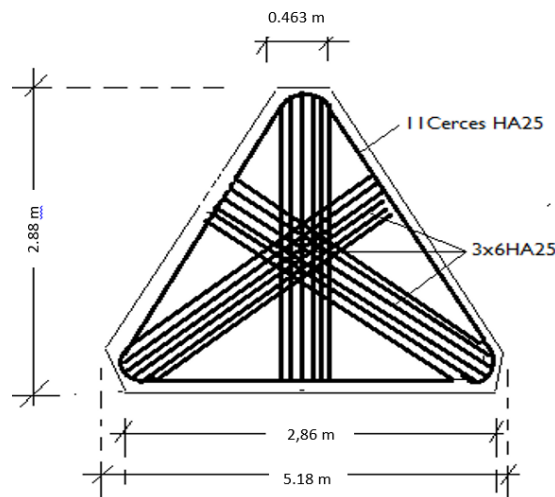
Schéma de ferrailage de la semelle sur 3 pieux
